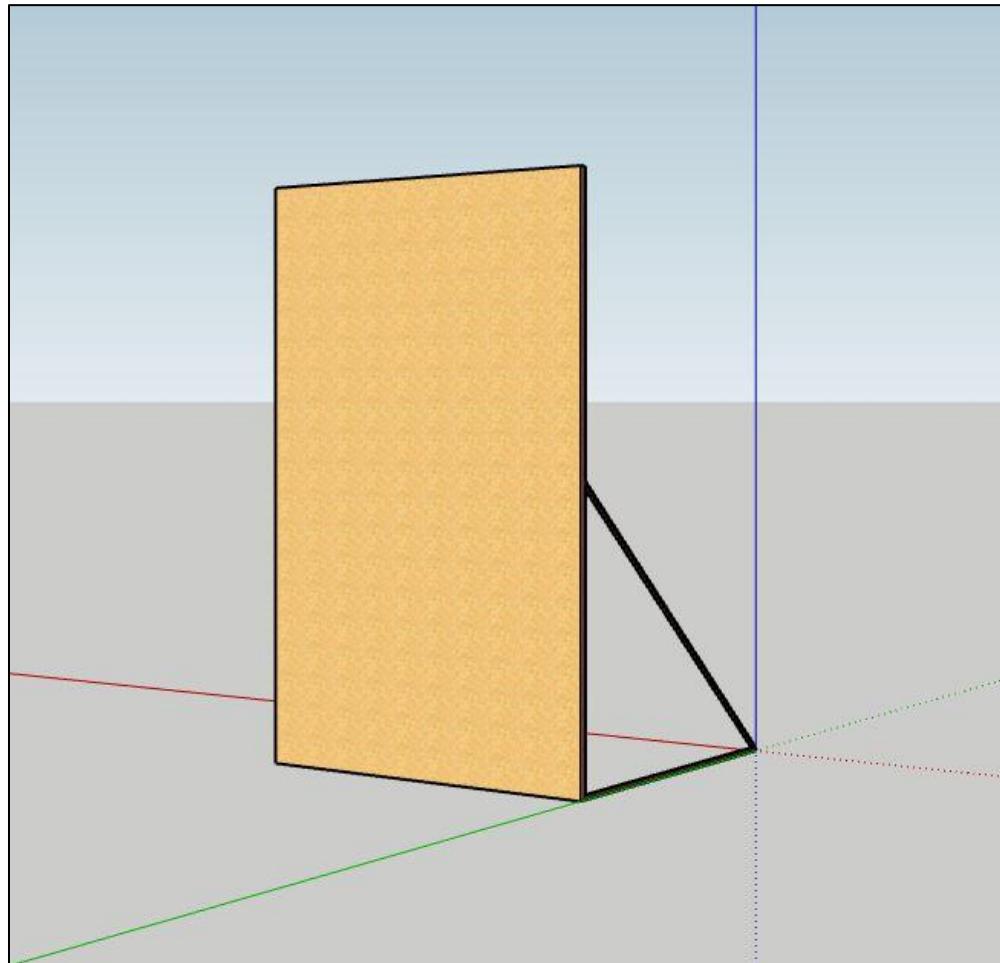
Barrera Acústica Móvil, vista exterior.
